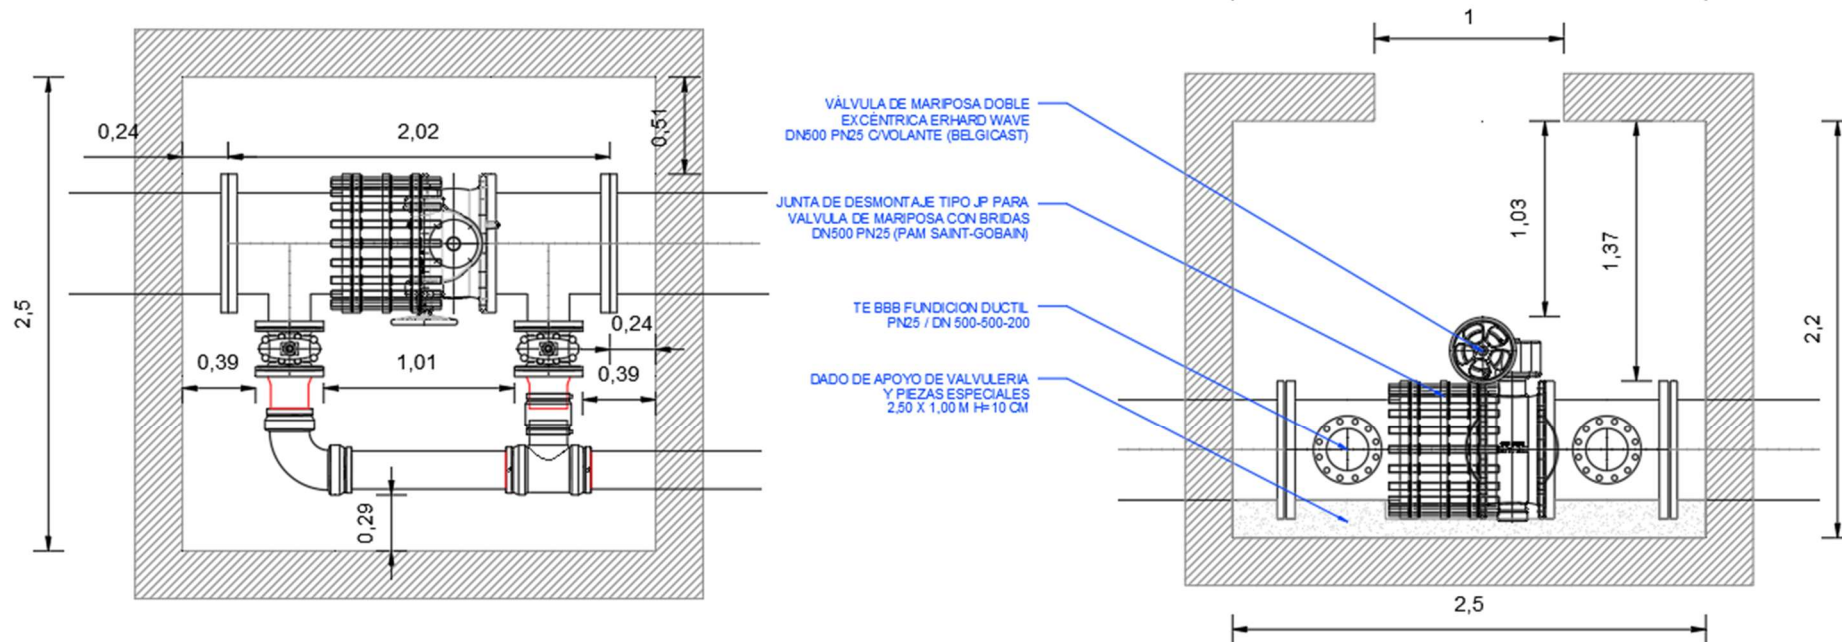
Planta General Acotada y Alzado de la Arqueta de Desagüe. Fuente: Elaboración propia
